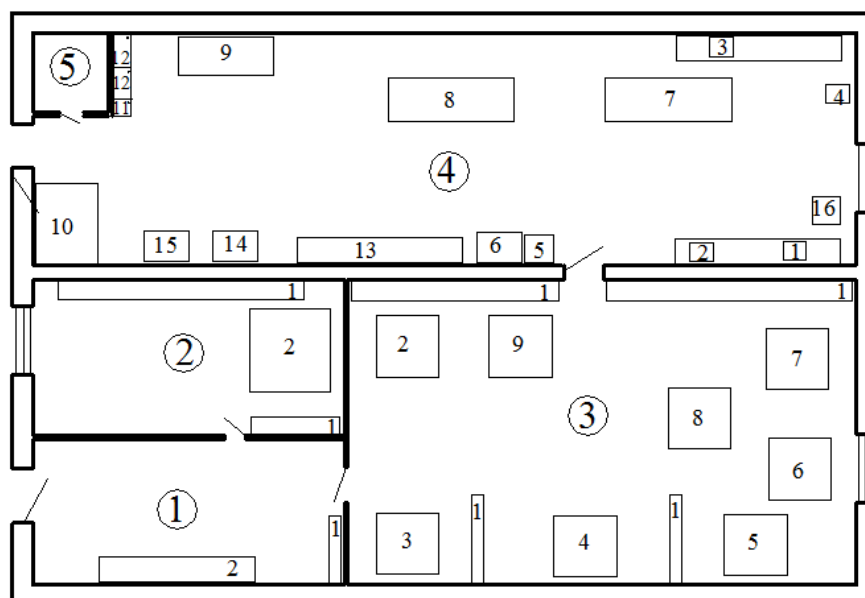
Схема строительной лаборатории предприятия по выпуску железобетонных изделий
